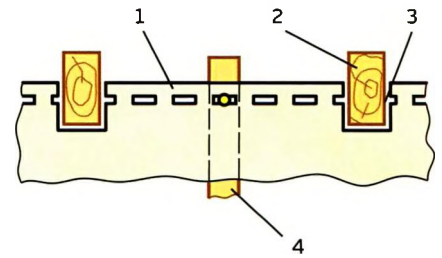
Установка верхней стеновой панели: 1 — панель; 2 — балка перекрытия; 3 — вырез; 4 — доска обрешётки.
